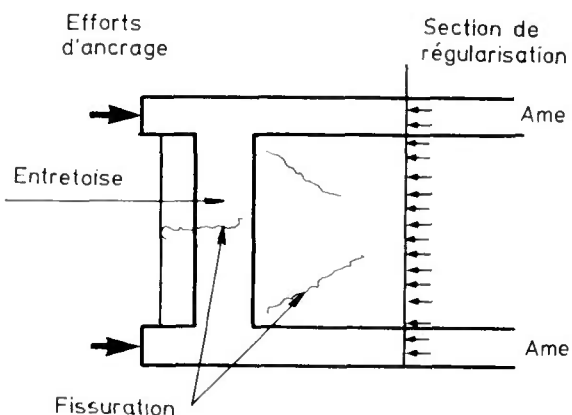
Fissuration du hourdis et de l'entretoise à l'about d'un tablier.
